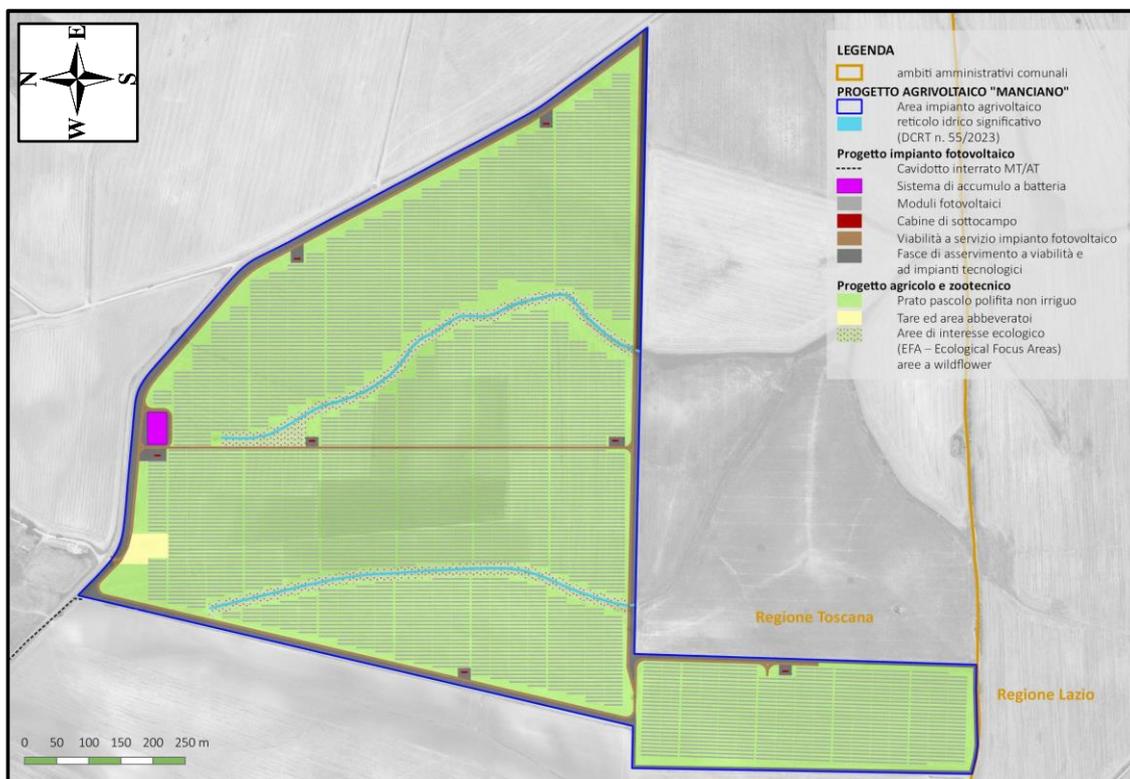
c *Layout del progetto agricolo (estratto da documento AV.MAN.DE.AM.R.041, con modifiche).
